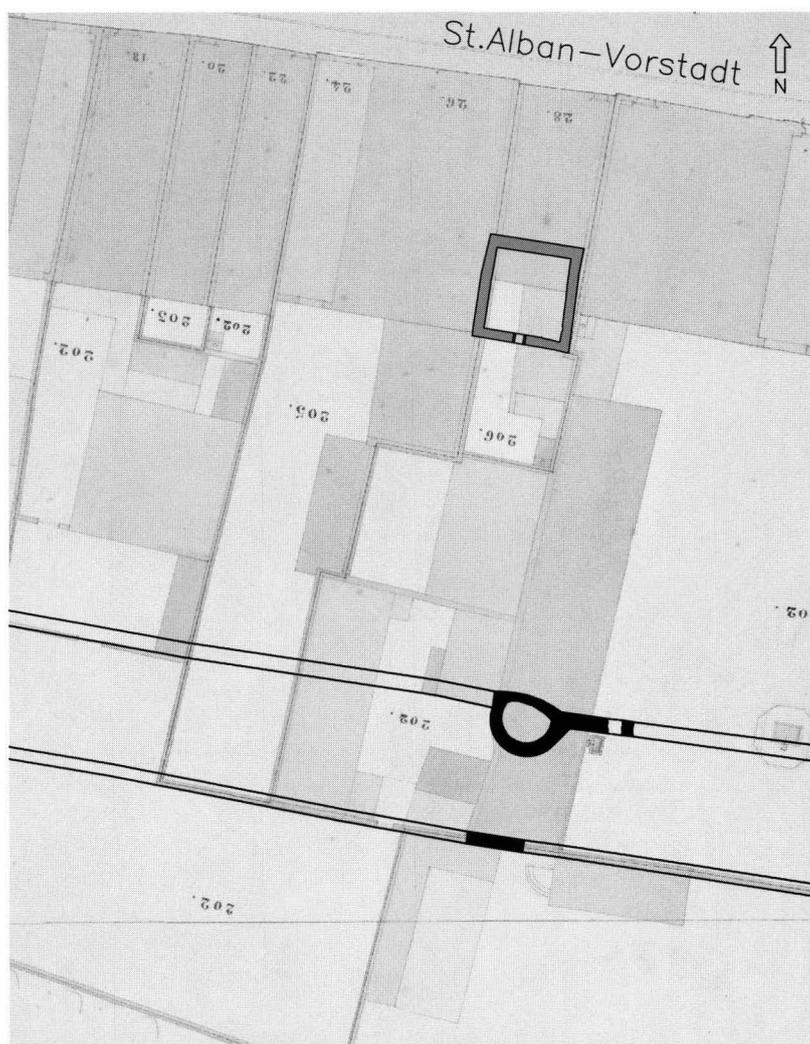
Abschnitt der Bebauung auf der Südseite der Inneren St. Alban-Vorstadt beidseits des Hauses Nr. 28. Ergänzt wurden der erschlossene Grundriss des Kernbaues (frühes 14. Jh.) sowie die Vorstadtbefestigung mit Schalenturm (ausgehendes 13. Jh.). Ausschnitt aus dem Grundbuchplan von Rudolf Falkner (Sektion V, Blatt 9), ca. 1871. – Zeichnung: U. Schön. – Massstab 1:500.
